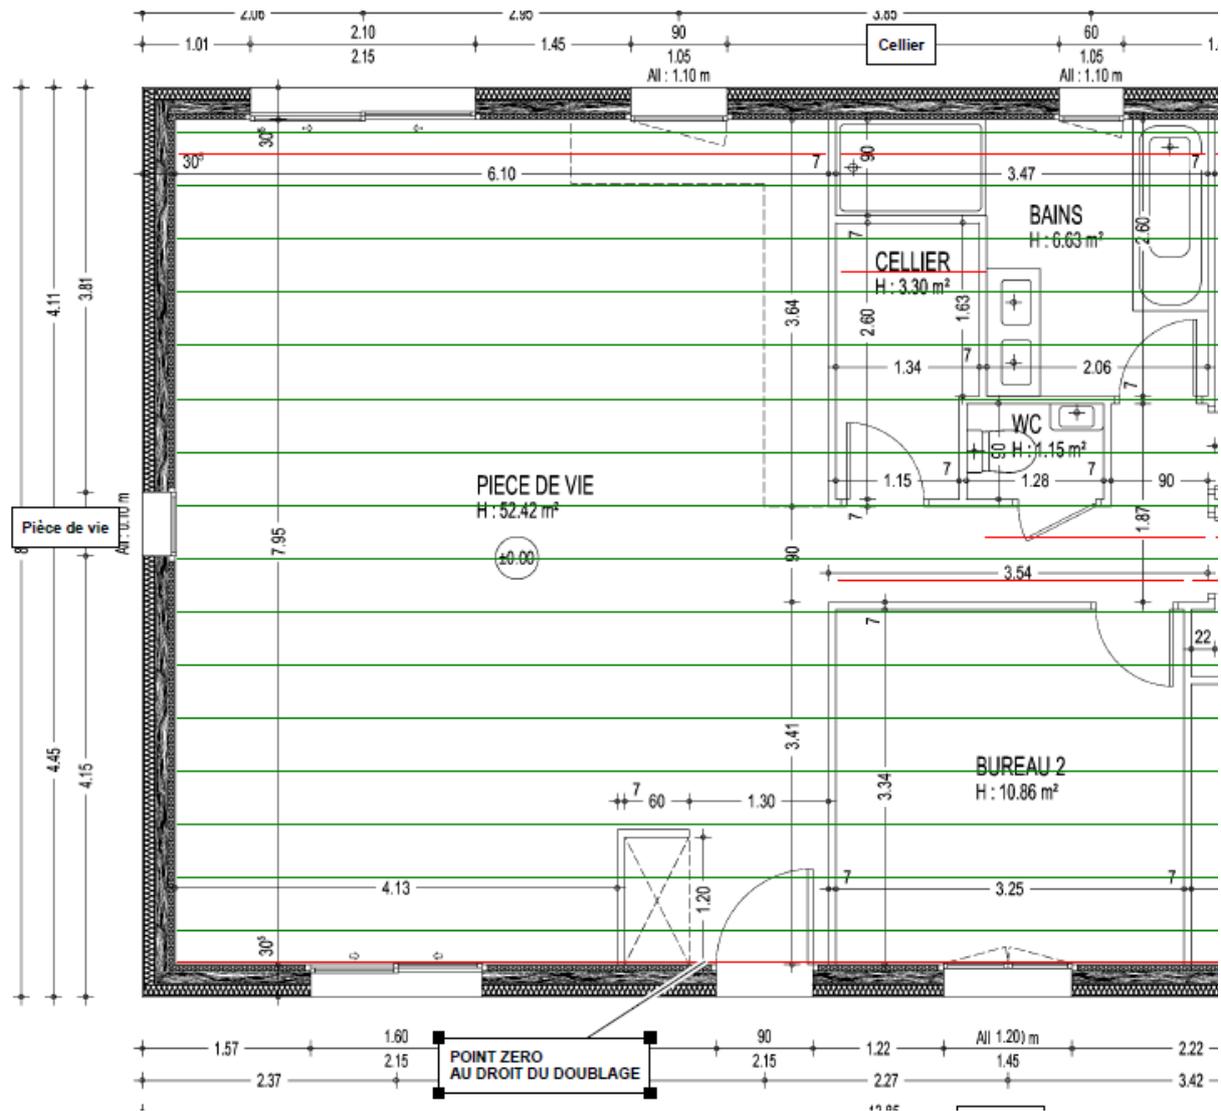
Plan de raillage fourni par ROTH (zoom d'un plan)
